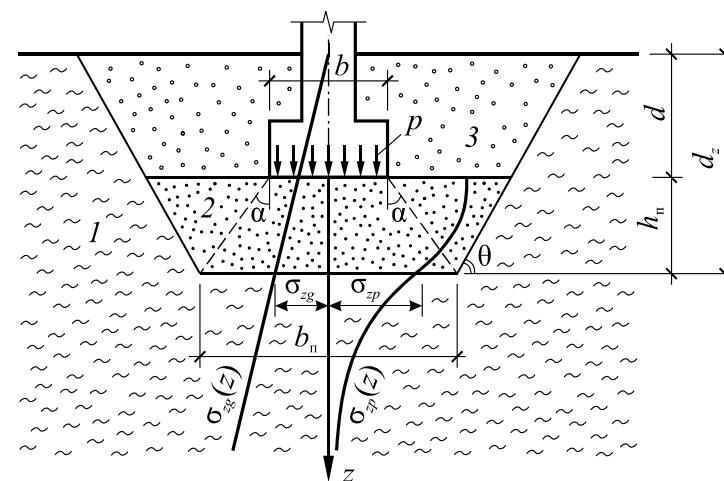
Схема к проверке давления на слабый подстилающий слой:
